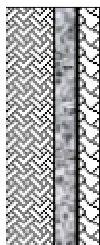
Sezione di una parete doppia con tramezzi separati da lana di roccia
